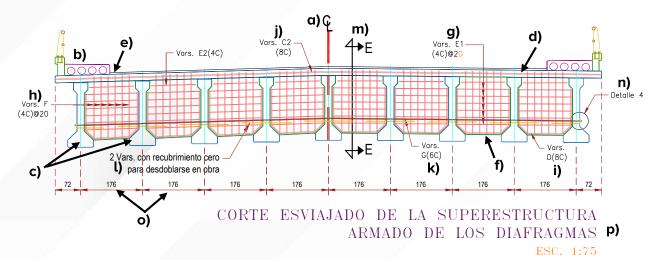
Ejemplo de corte esviajado de la superestructura, armado de los diafragmas
